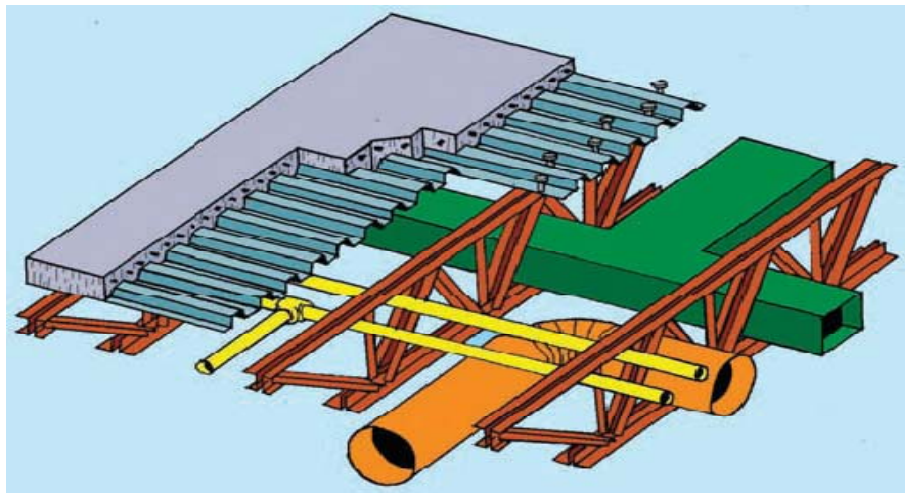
Elementos estructurales y no estructurales que contienen la carga muerta
